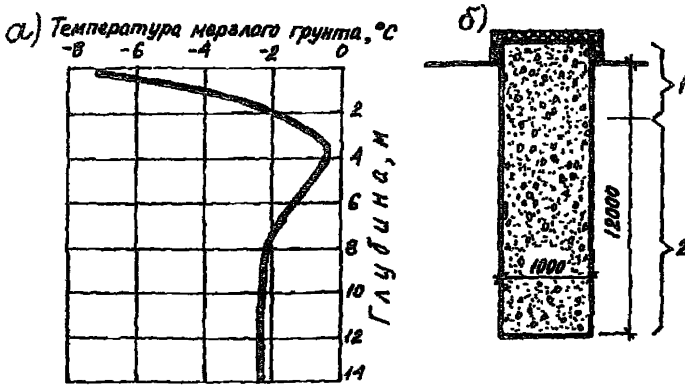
Температура грунта (а) и схема буронабивной свай (б): 1 – зона электропрогрева бетона, 2 – зона термического удерживания бетона
